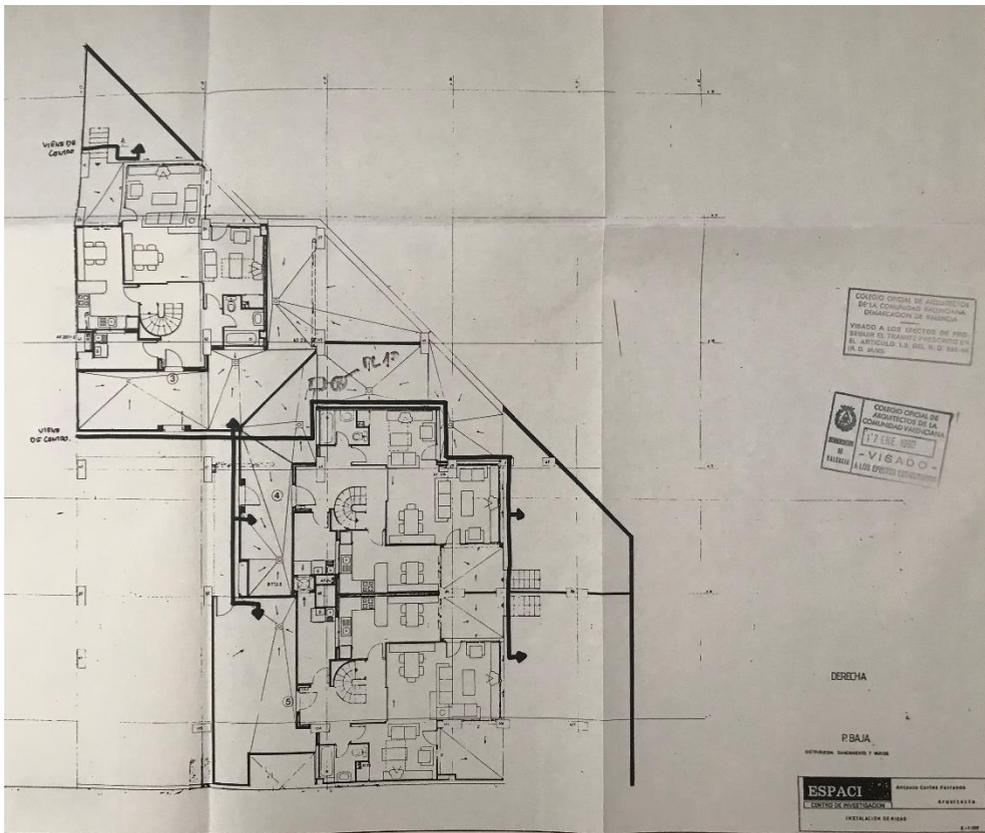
Plano sistema de riego en planta baja. Proyecto 1992. fuente: Archivo personal de Cortés.
